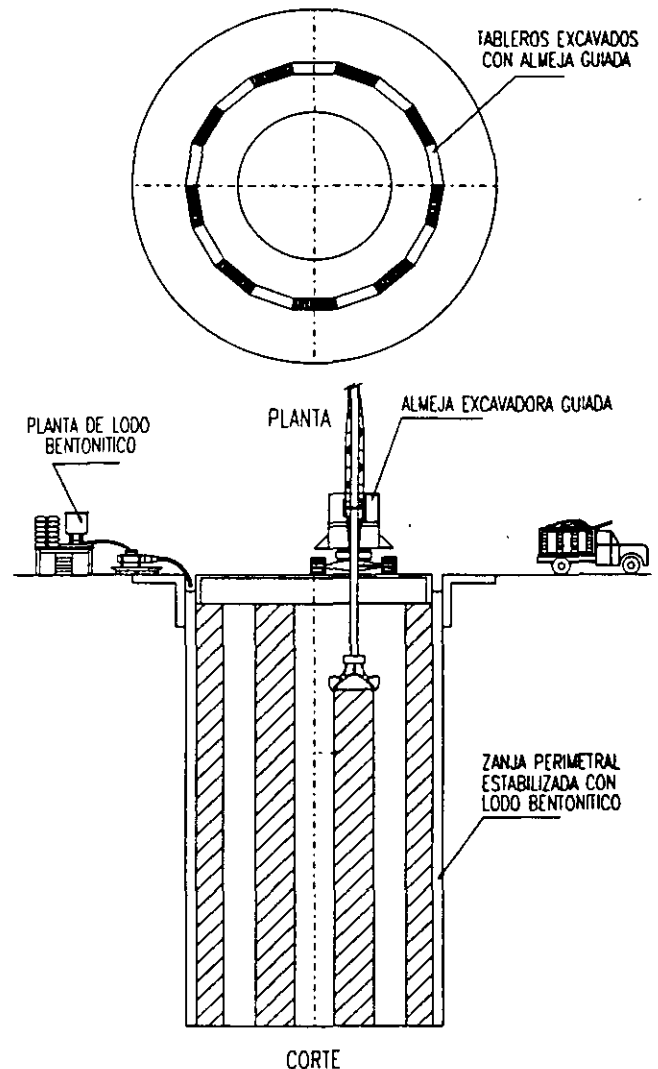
EXCAVACIÓN DE ZANJA PERIMETRAL
